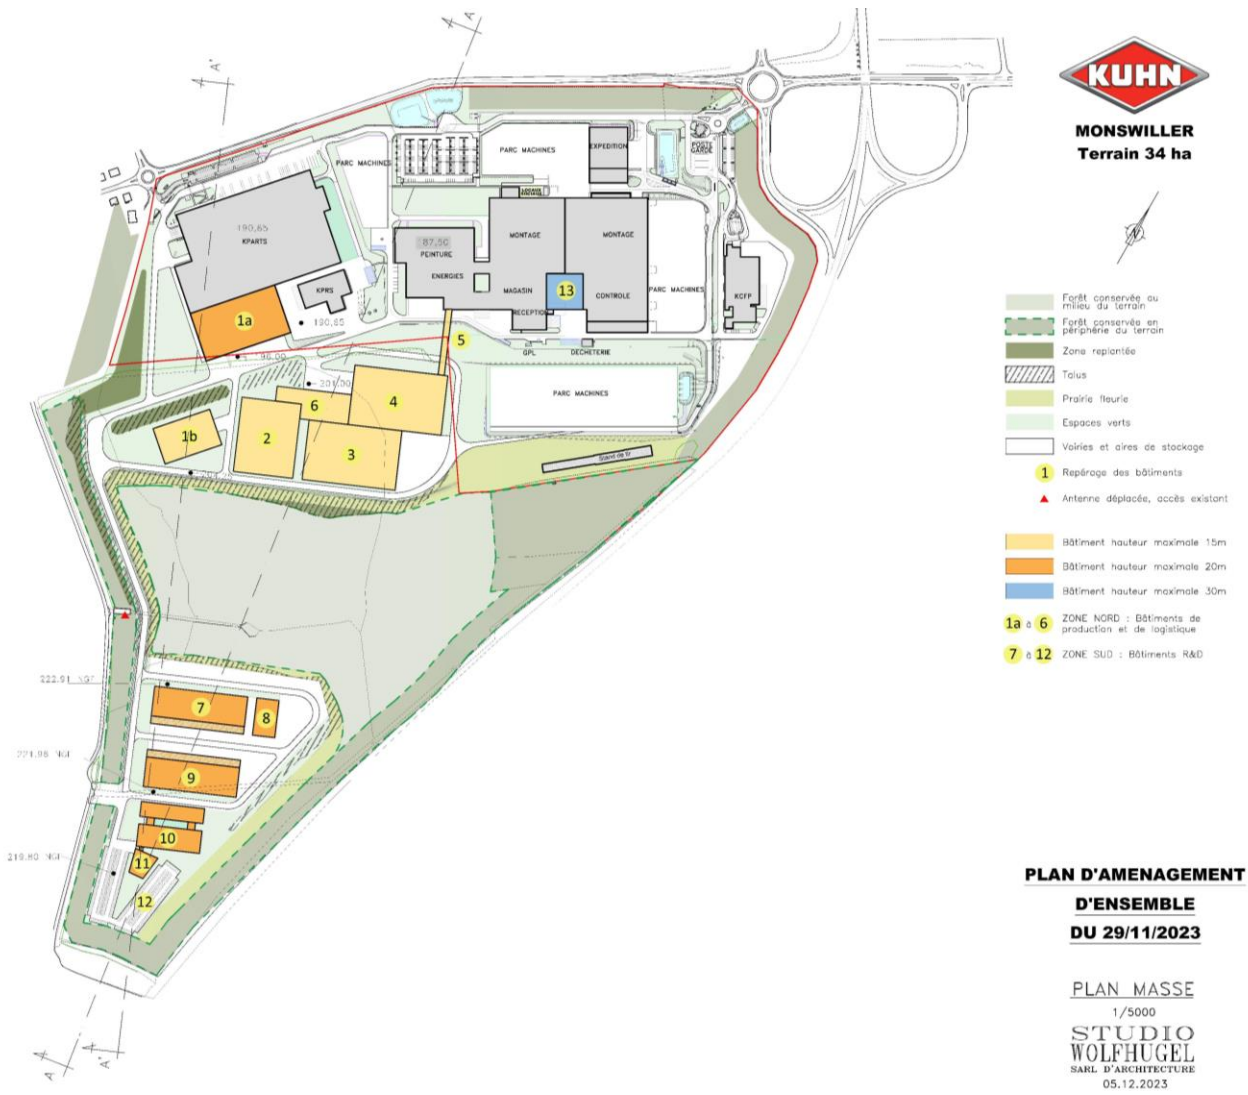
PLAN MASSE DU PROJET D'AGRANDISSEMENT DU SITE DE KUHN
